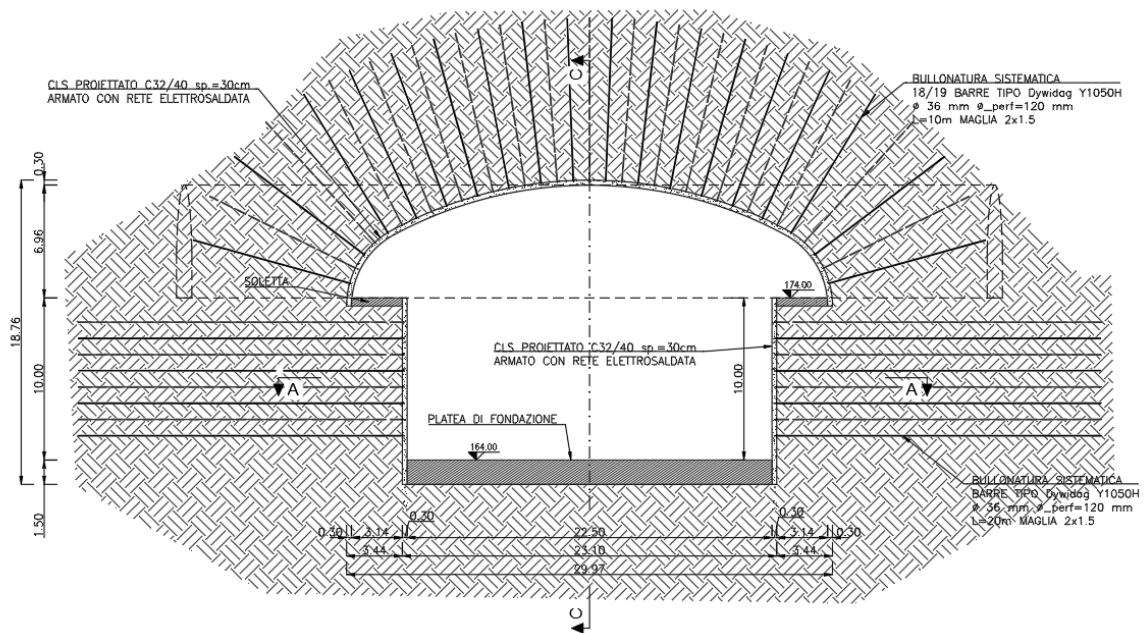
Sottostazione elettrica, sezione trasversale
